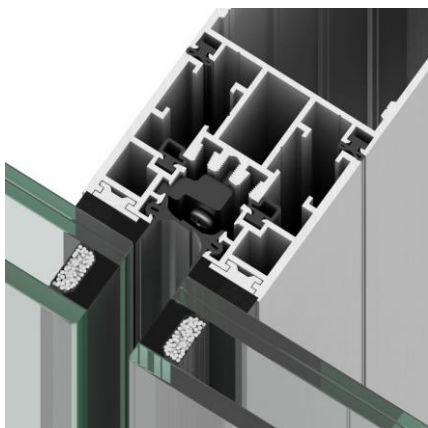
Sistema de muro cortina tipo Stick R70ST de Riventi para fachadas especiales y dobles pieles, con fijación de silicona estructural a través de bastidor (I). (Riventi, 2015)
